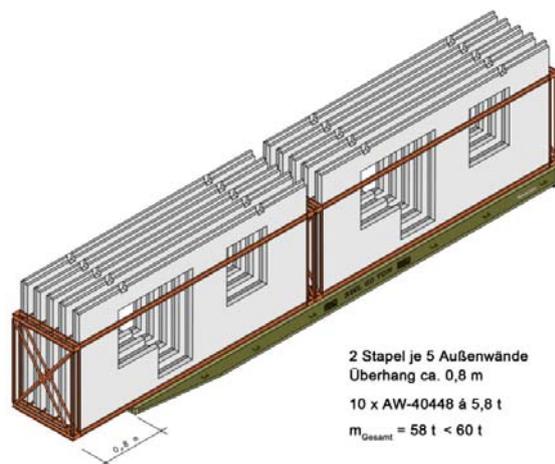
Variante der Beladung eines 40' RoRo-Trailers mit 10 Außenwänden (L: 6,00 m) mit Überhang; Darstellung ohne Ladungssicherung
